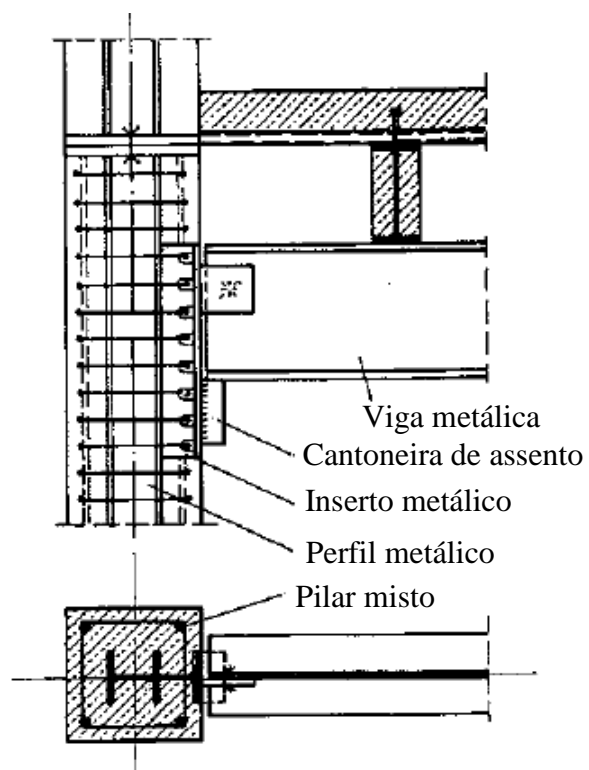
Ligação mista viga-pilar resistente a momento [BODE (1998)]
